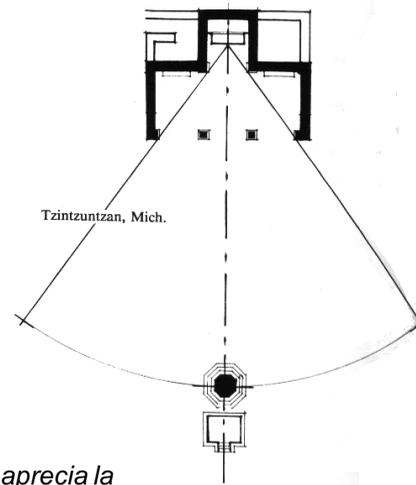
Planta y vista de la capilla abierta de Tzintzuntzan, se aprecia la nave transversal al frente del presbiterio.
